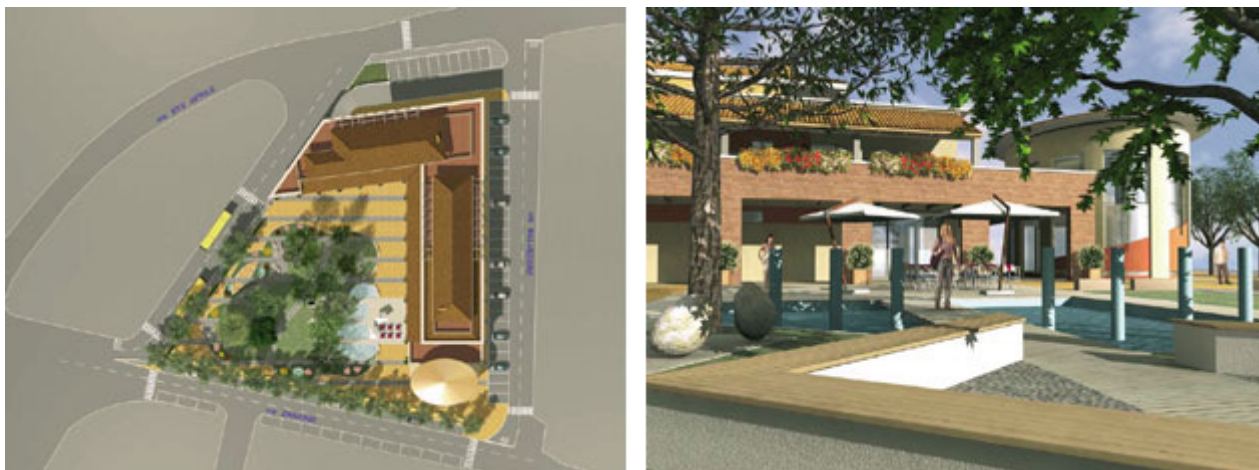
Planivolumetrico di insieme (sx) e vista prospettica dal parco interno del complesso di Soncino (dx).
